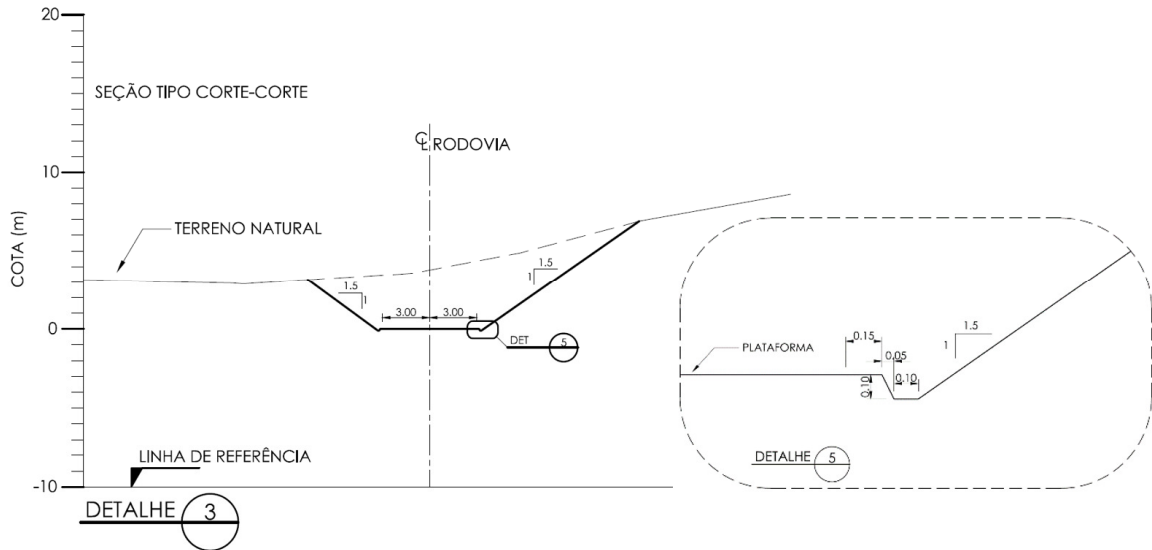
Seção transversal tipo corte-corte – detalhes 3 e 5 (estaca 33+820.00 m).
